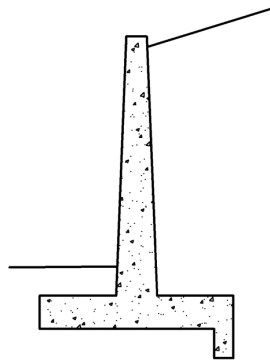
Exemple d'un mur avec bêche à l'arrière (la bêche peut être disposée soit à l'arrière du talon, soit à l'aplomb du voile, soit à l'avant du patin)
